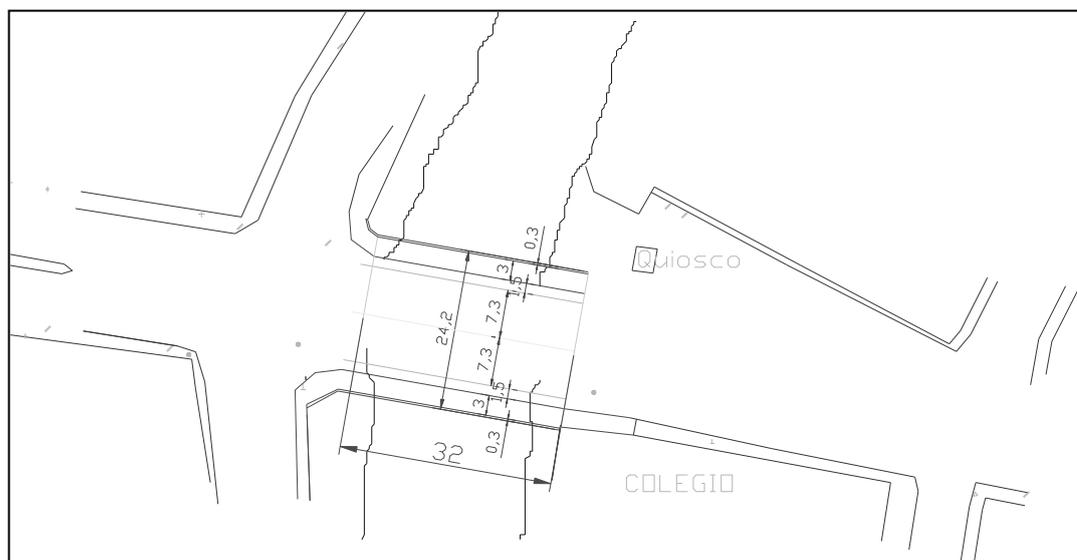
IMPLANTACIÓN PROPUESTA PARA EL PUENTE 17 DE SEPTIEMBRE.
